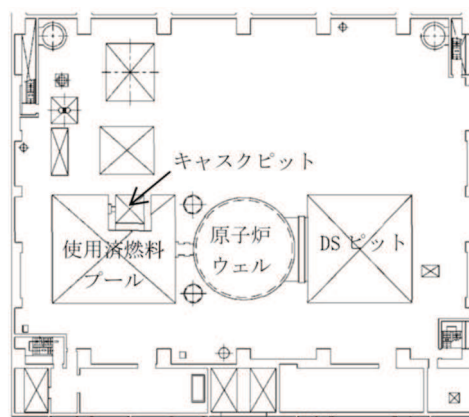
原子炉建屋 3 階の機器配置図 (平面図)
